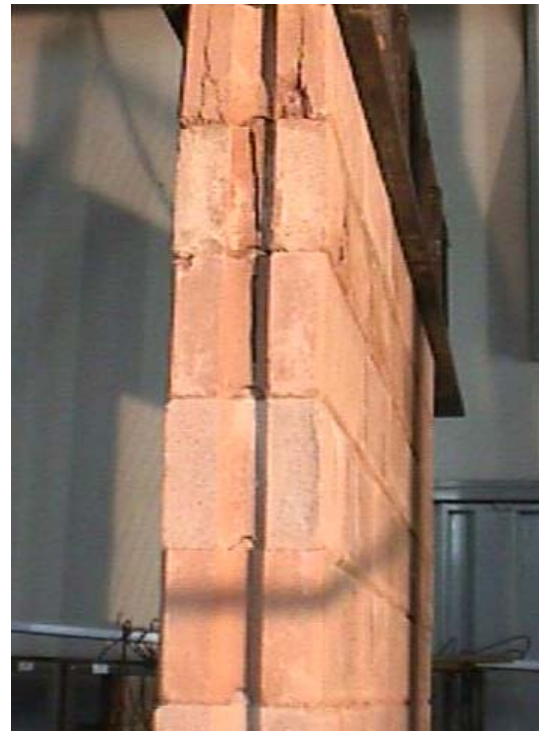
(à esquerda) – Fissuração da parede P2 com 24 fiadas, face sul superior, durante a aplicação de carga
